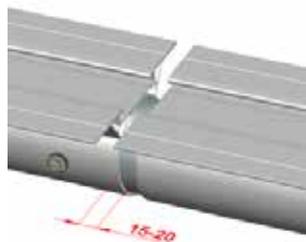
Aufstecken der nachfolgenden LB Rohrpfette 80 mit Dehnungsabstand
